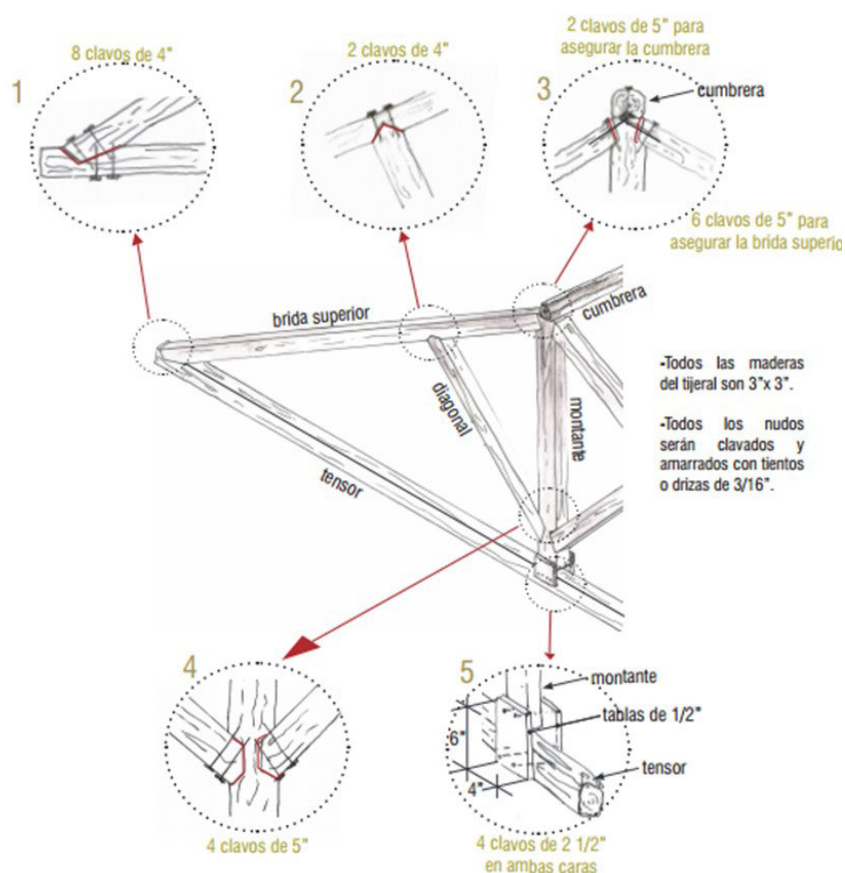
Estructura de refuerzo de la cubierta Fuente. Elaborado por el ministerio de vivienda, construcción y saneamiento Carlos Maldonado Herrera Director Nacional de Construcción de Perú equipo técnico Arq. Roberto Prieto Sánchez, Ing. Julio Vargas Newman Junio 2014
